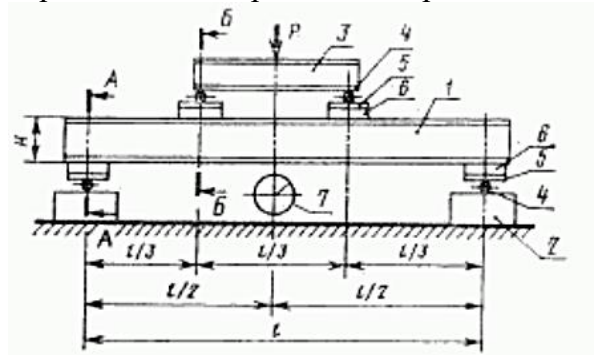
Схема испытания образца сэндвич-панели на поперечный изгиб (цифрами обозначено: 1 – образец, 2 – база, 3 – траверса, 4 – цилиндрические опоры, 5 – стальные пластины, 6 – прокладки, 7 – прибор для измерения деформаций)
